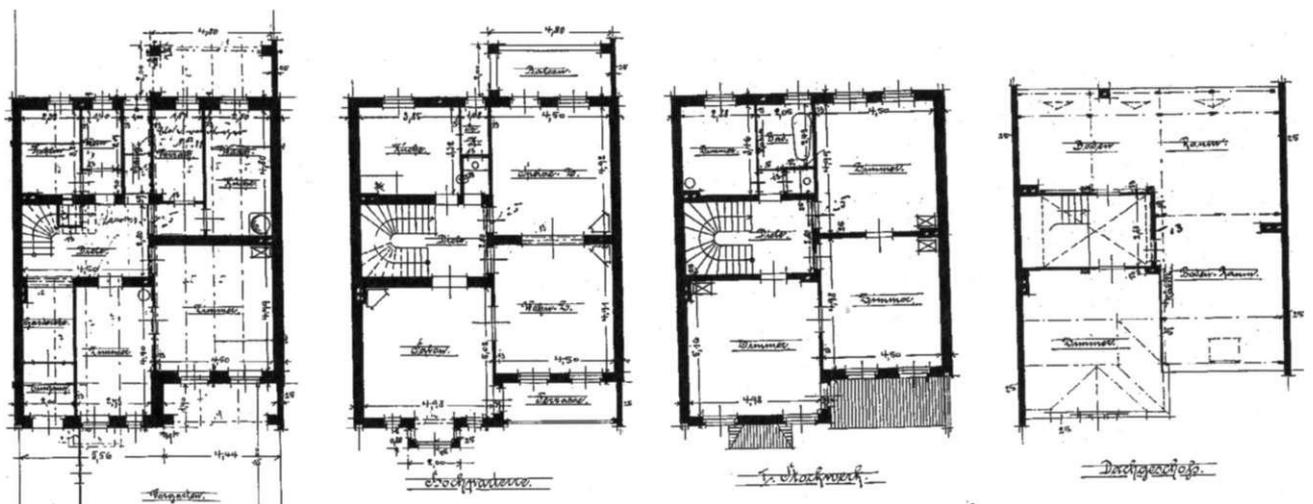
Grundrisse der einzelnen Etagen Gerhart-Hauptmann-Straße 52
